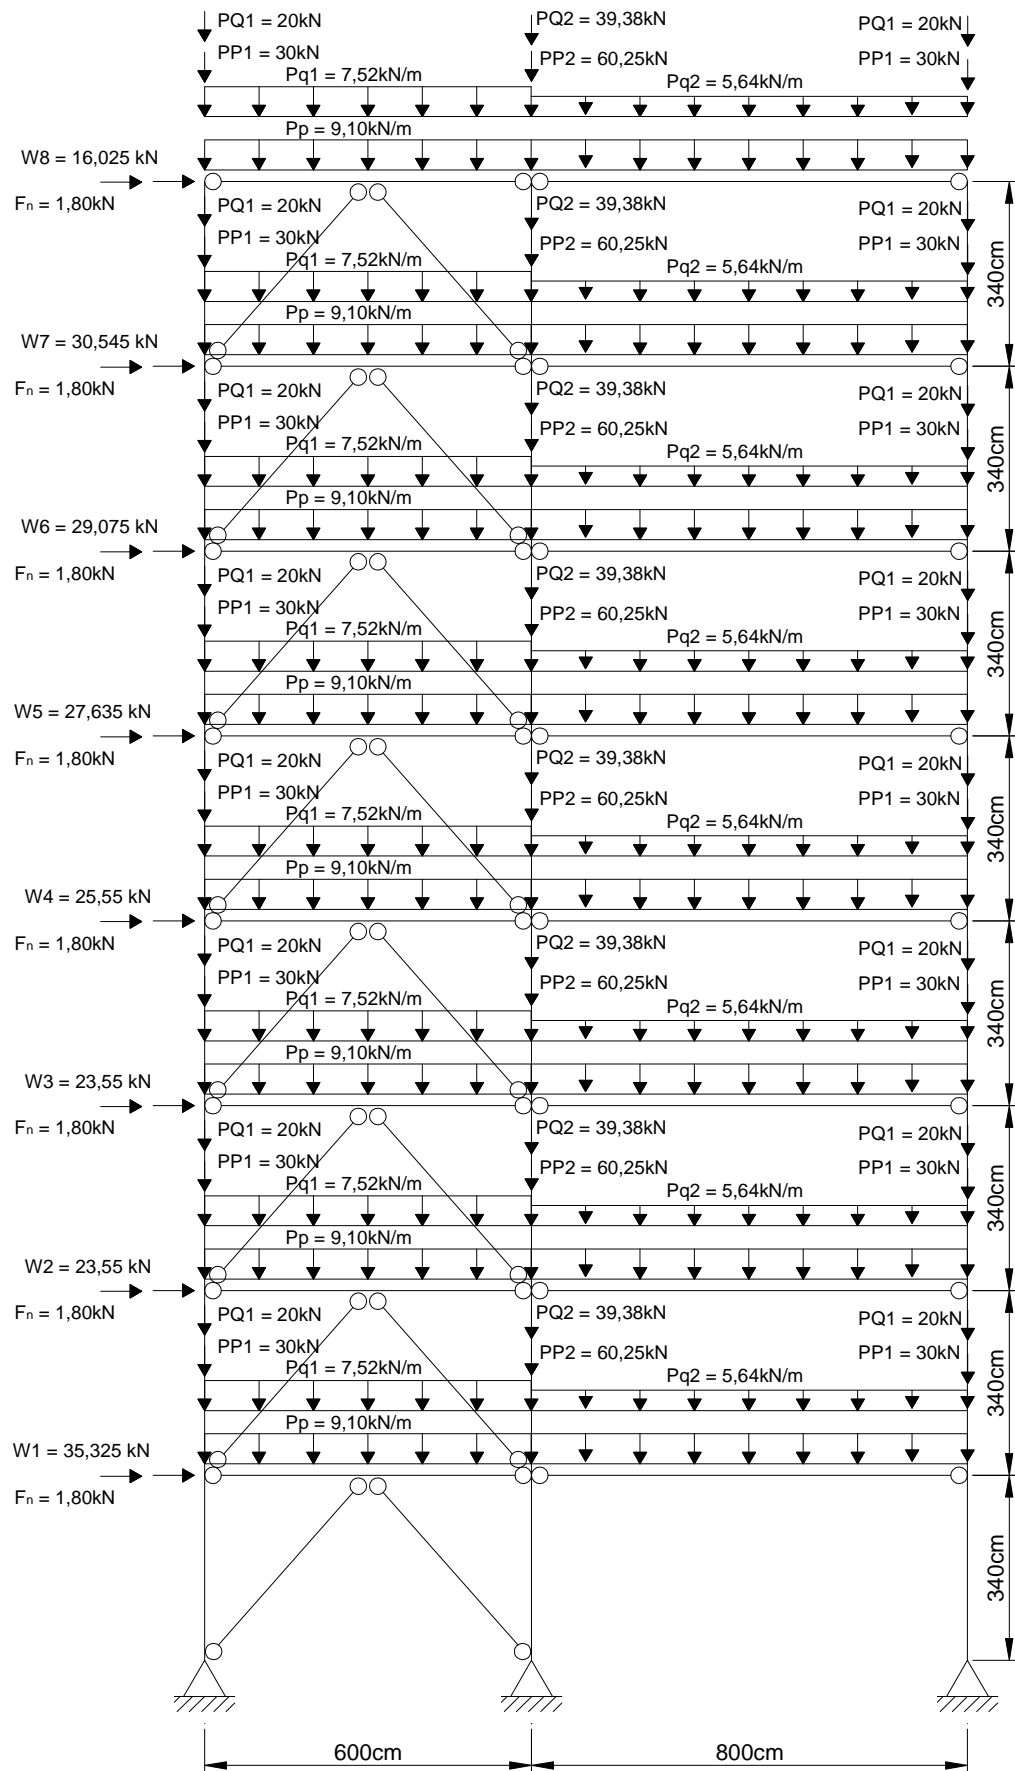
Pórtico contraventado de oito pavimentos, com as ações aplicadas com seus valores característicos.
